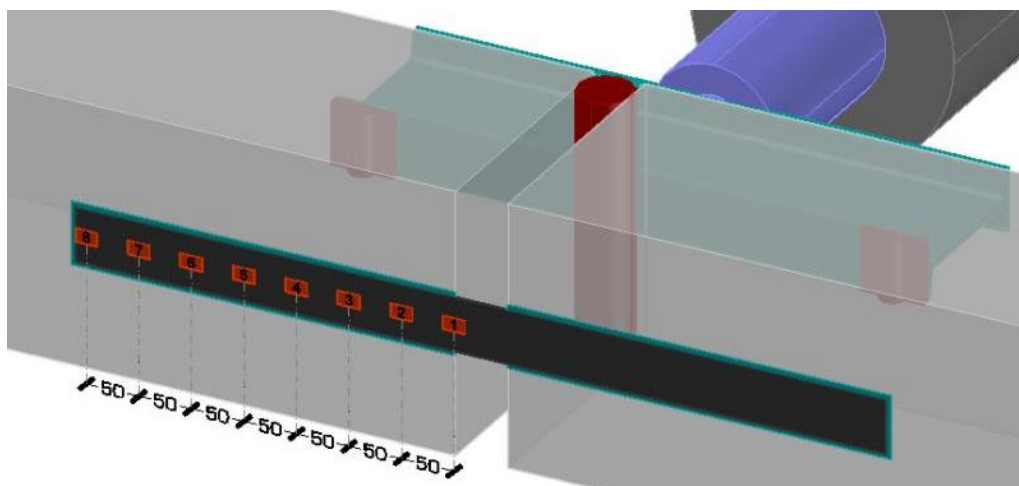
Configuración ensayo CS05, dimensiones en mm.
